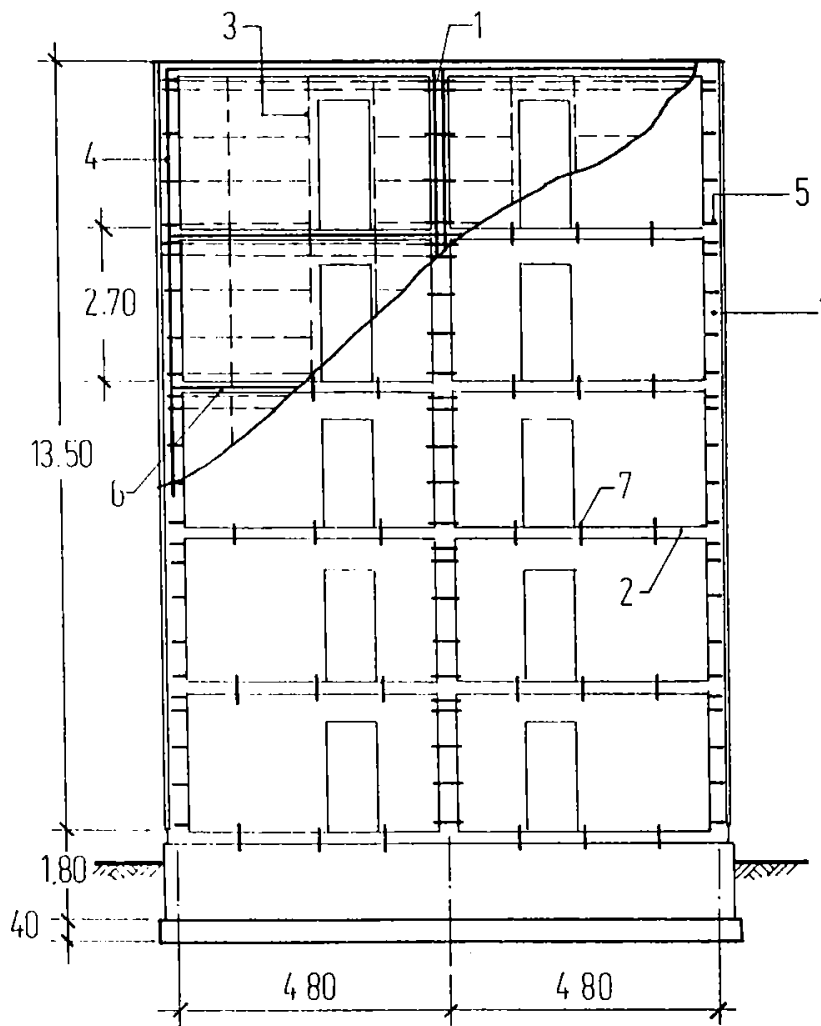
ELEVATIJA UNEI DIAFRAGME VERTICALE PREFABRICATE
